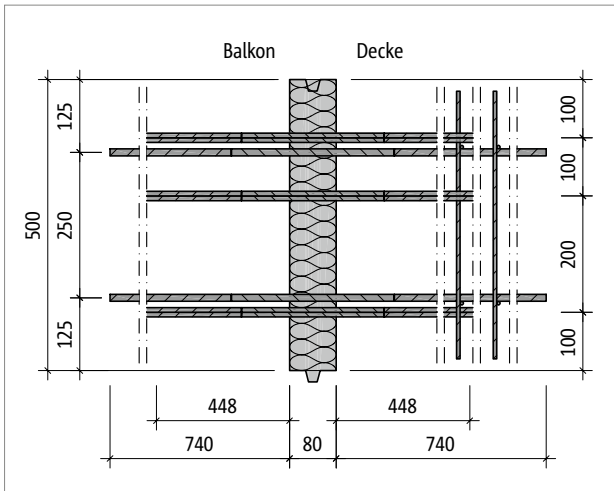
Schöck Isokorb® T Typ DP-MM1-VV3: Grundriss
